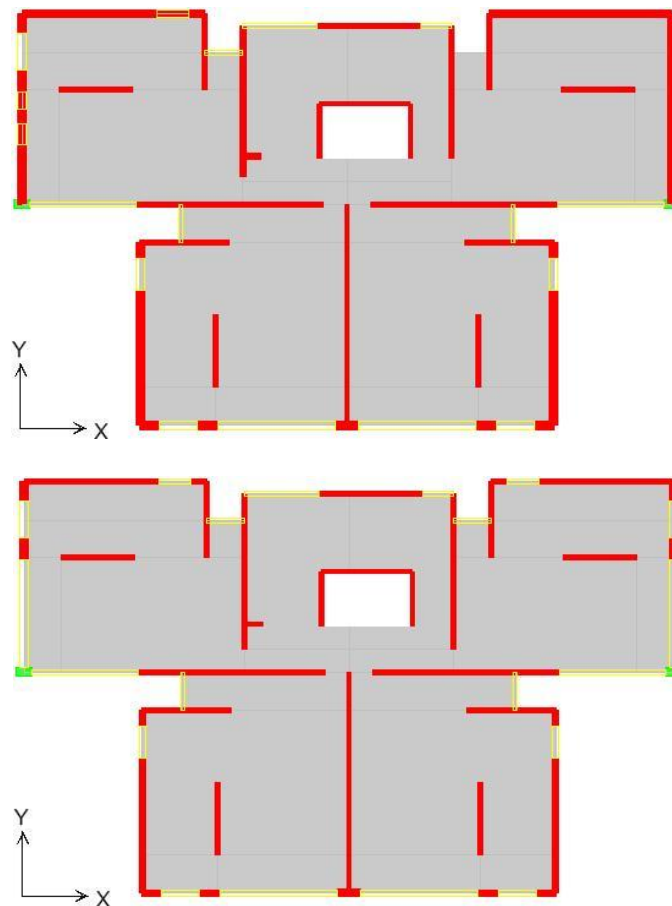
Planta primer piso (arriba) y piso tipo (abajo) edificio H10
